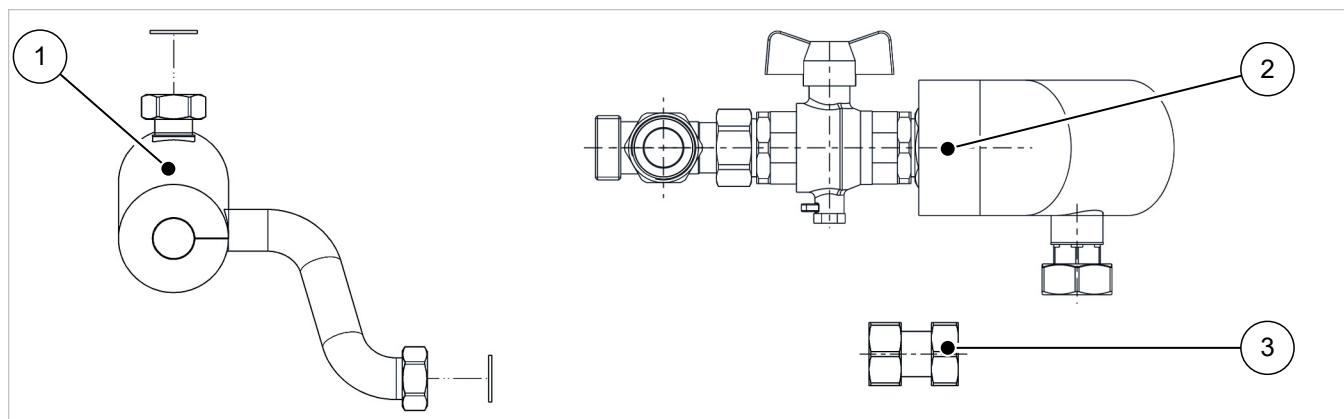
Anschlusssatz zum Einbau eines Warmwasser-Wärmemengenzählers in SolvisMax mit Wärmepumpe
